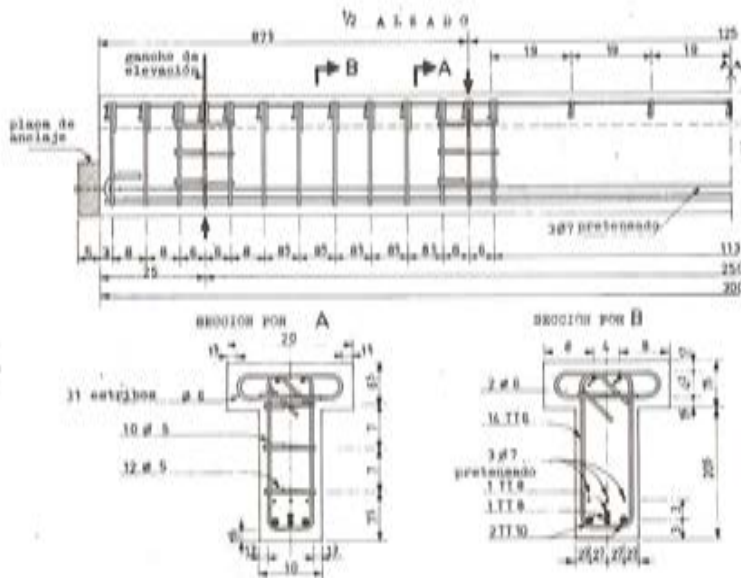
Armaduras de las viguetas B3 y B3'.
